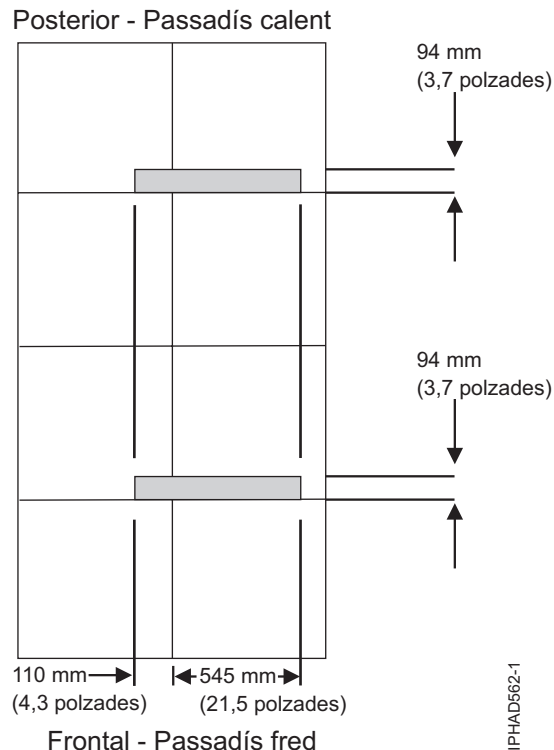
Col·locació de l'obertura de cables en les plaques de 600 mm (23,6 polzades)
